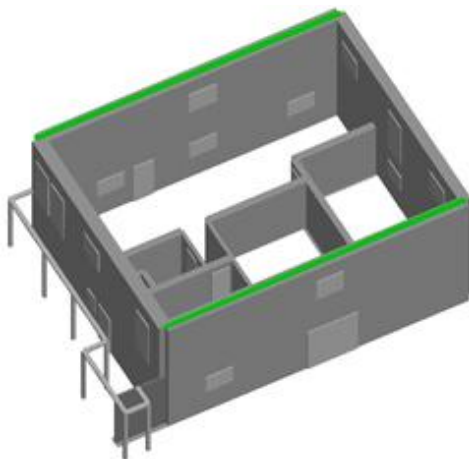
Esquema de introdução de tirantes ao nível do pavimento do sótão nas fachadas laterais
